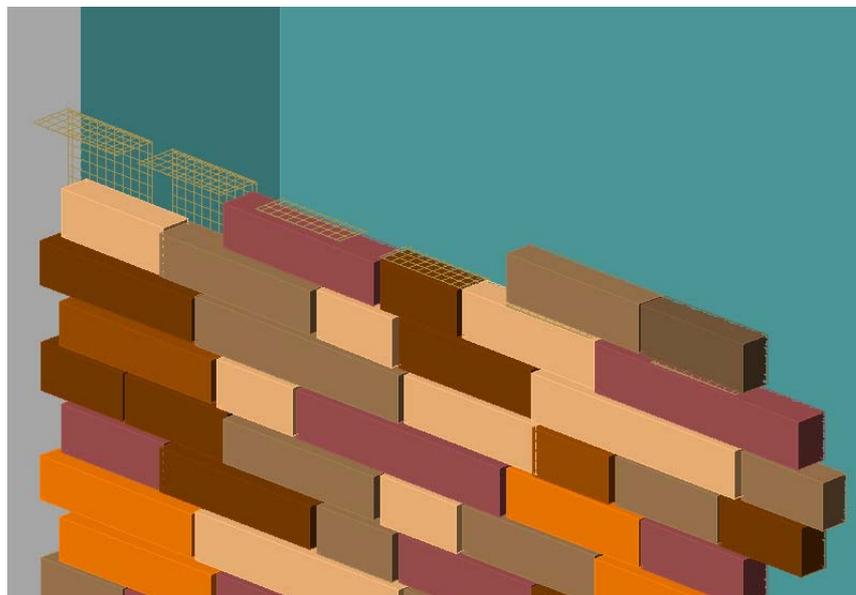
Detalhe do revestimento de fachada em filetes de pedra natural sobre a alvenaria, sobre a qual são fixadas telas para dar o suporte requerido pelo revestimento.
